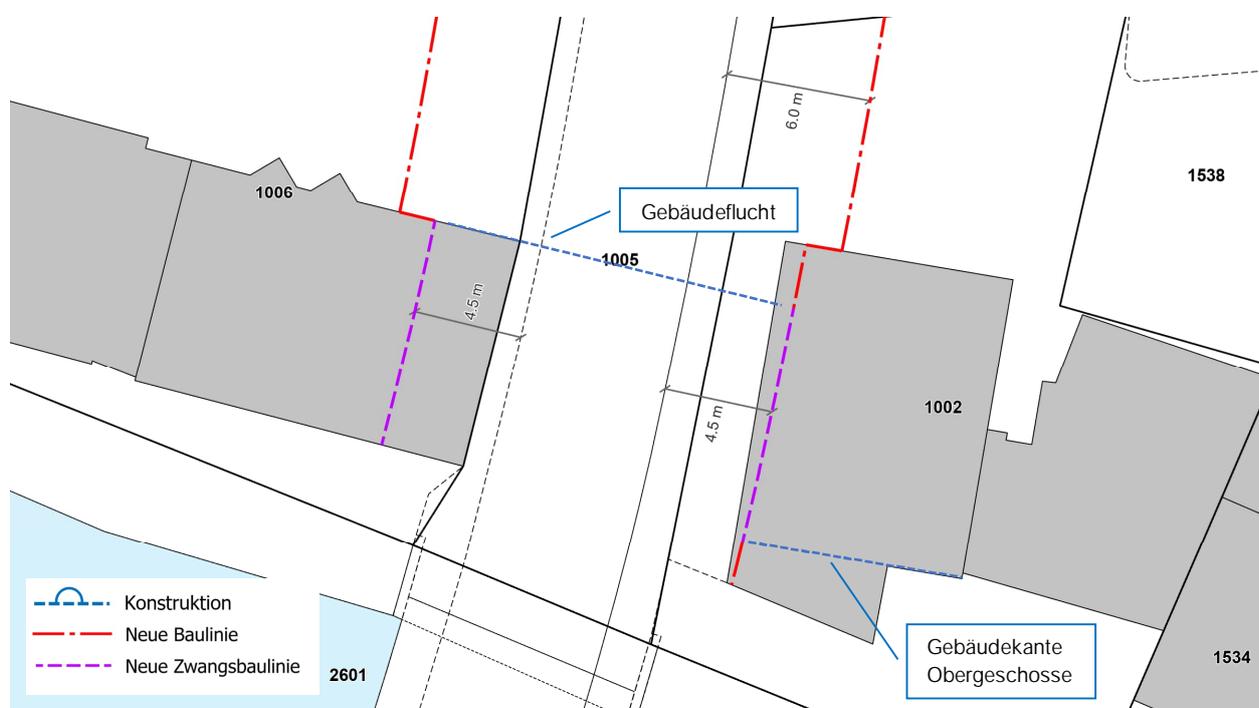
Detailansicht Baulinienführung Engstelle am Brückenkopf mit Konstruktionslinien in blau zur Information (ohne Massstab, genordet)
